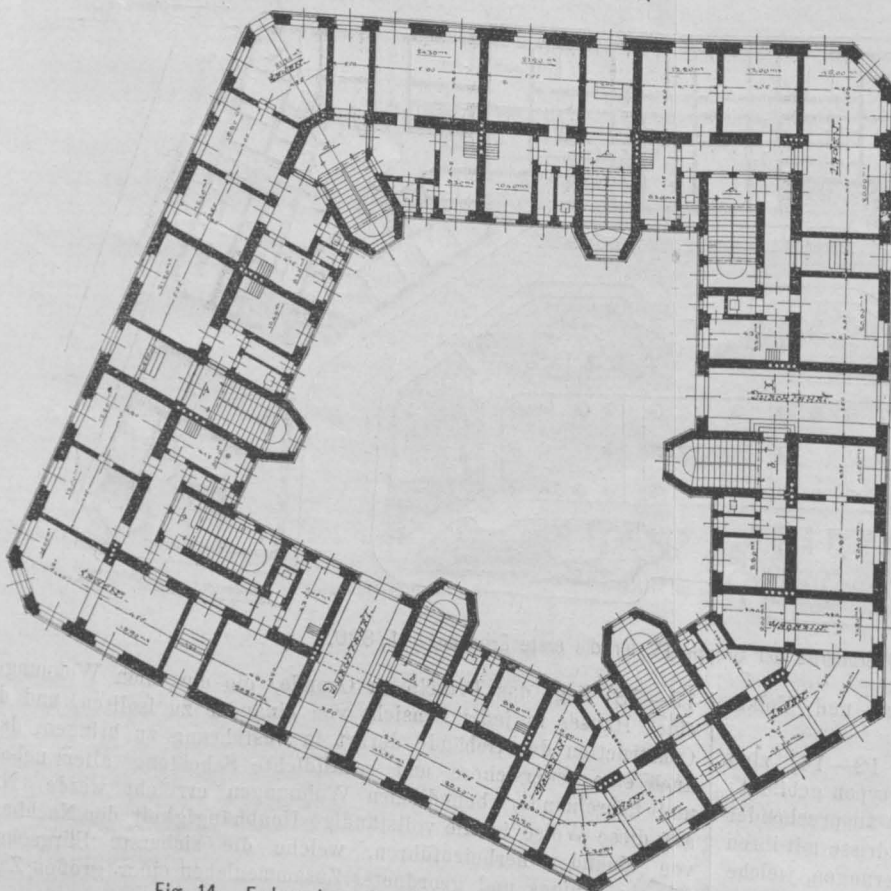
Erdgeschoss-Grundriss der Gebäudegruppe I. 1:400.
